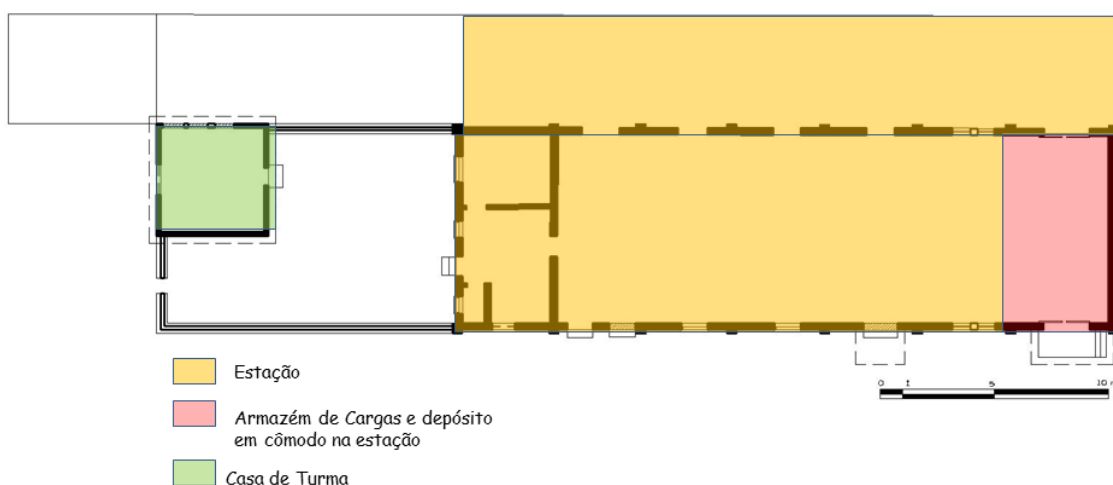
Planta da estação da Stevenson construída pela CMEF.
